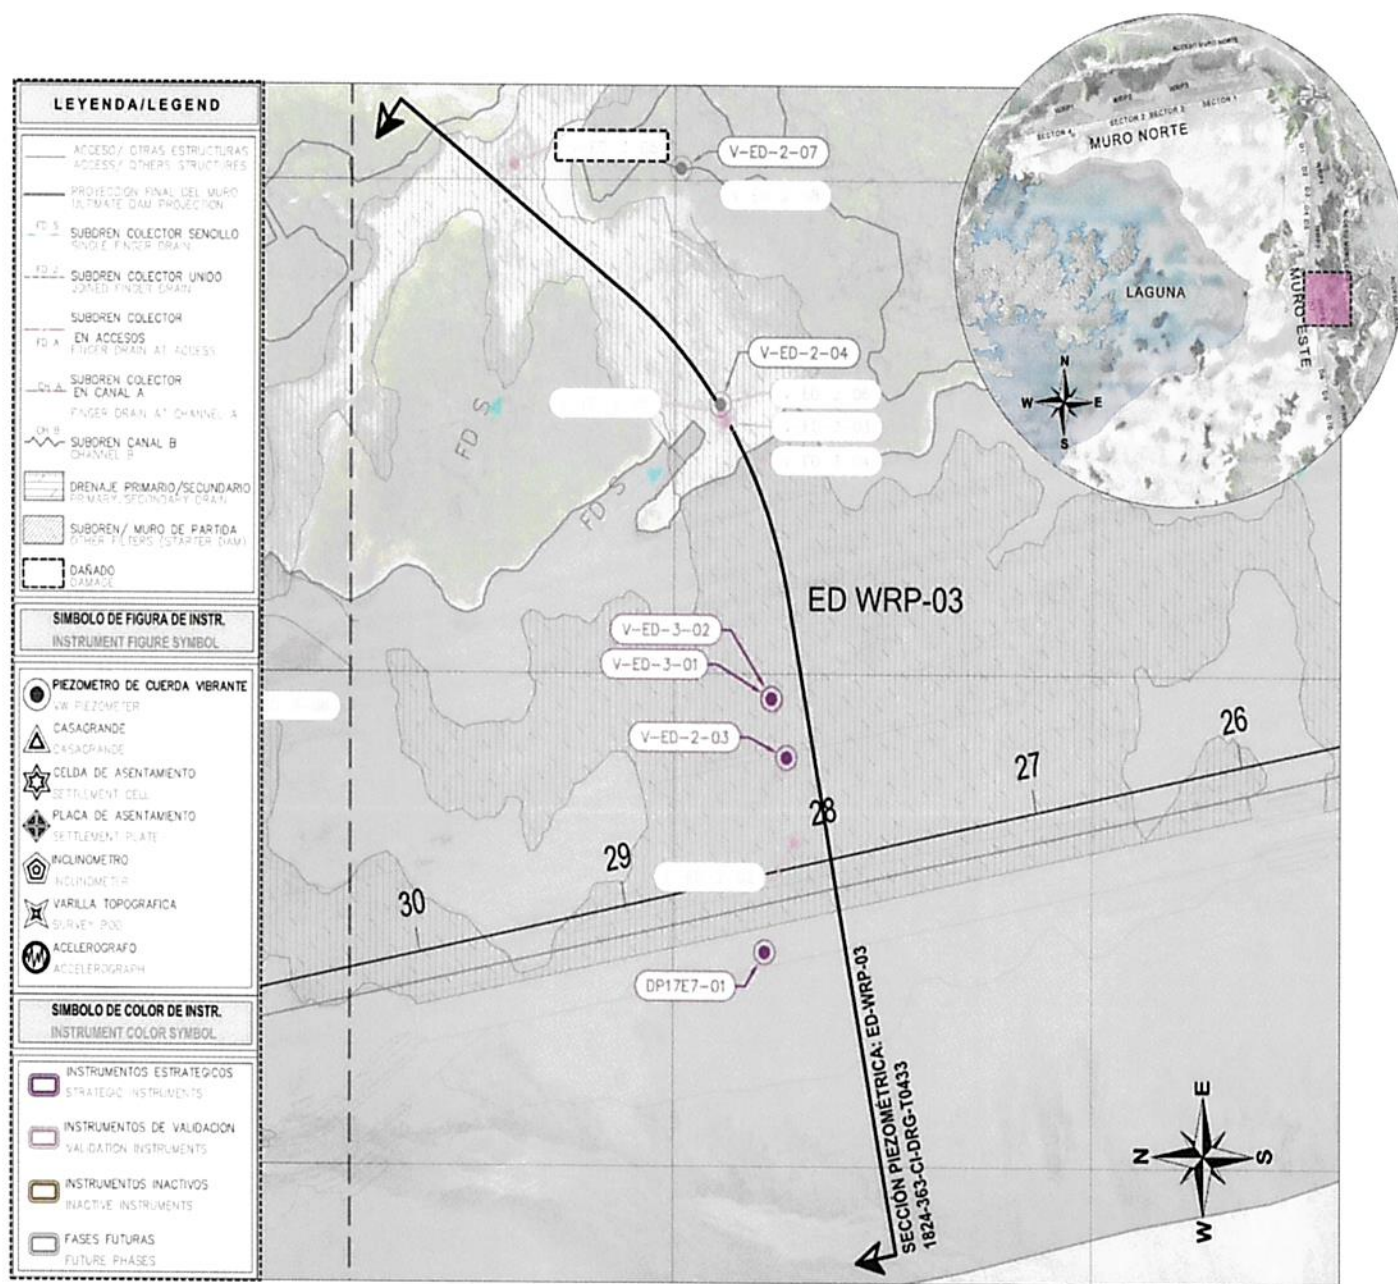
Vista de Planta en el Muro Este WRP3 con Piezómetros
